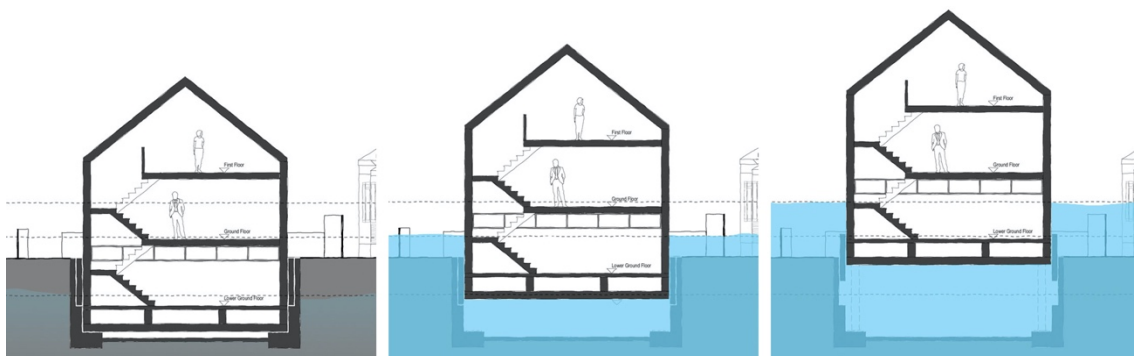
Cortes Transversais de Amphibious House de Baca Architects (Fonte_20)
